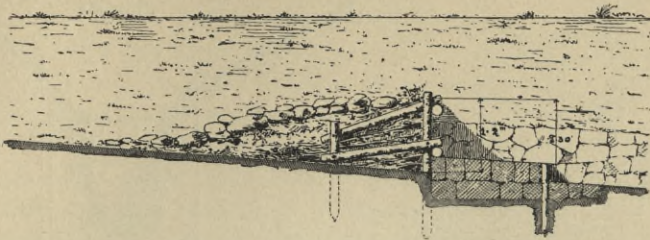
Holzsperrre, 2 m hoch. b Querschnitt.
